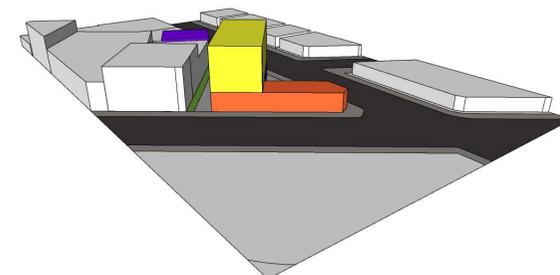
Opção 02 vista da Av. João Pessoa |
